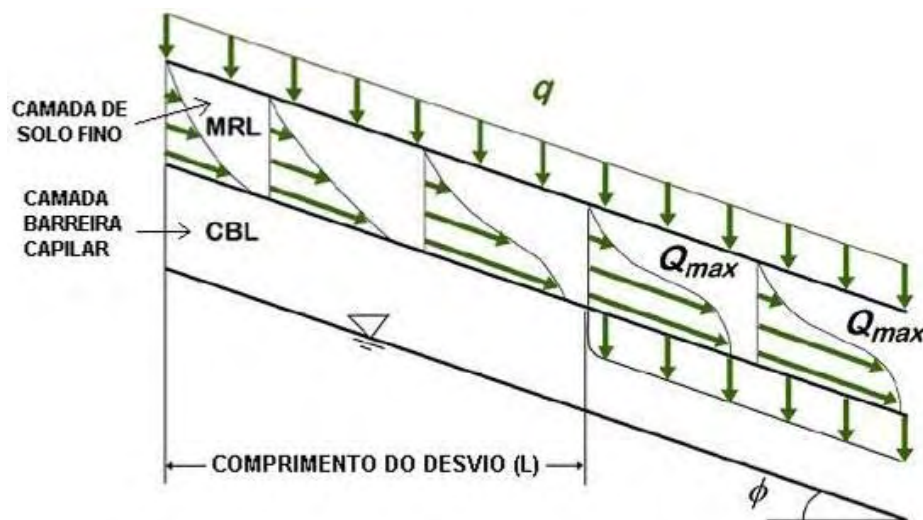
Perfil de uma barreira capilar inclinada (adaptado de Parent & Cabral 2006).
